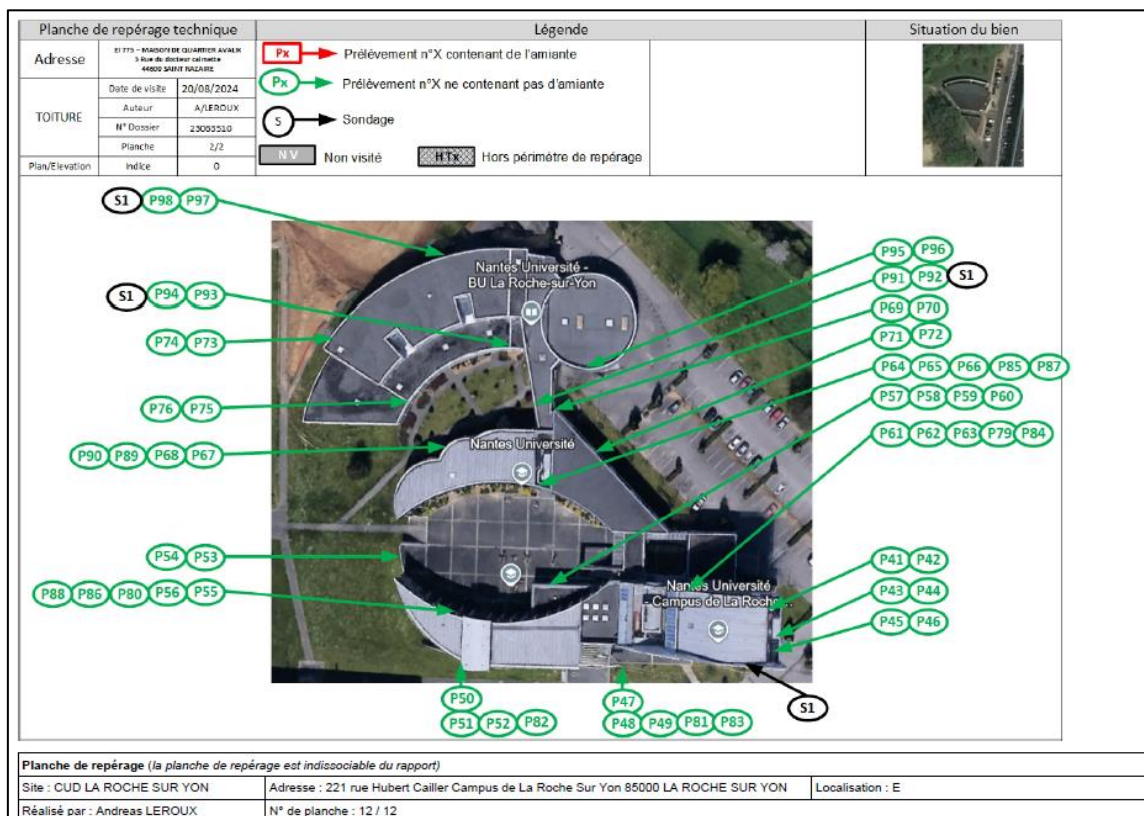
Plans de localisation des MPCA et des prélèvements sur les toitures-terrasses et murs-rideaux extérieurs bâtiment E, F et G
